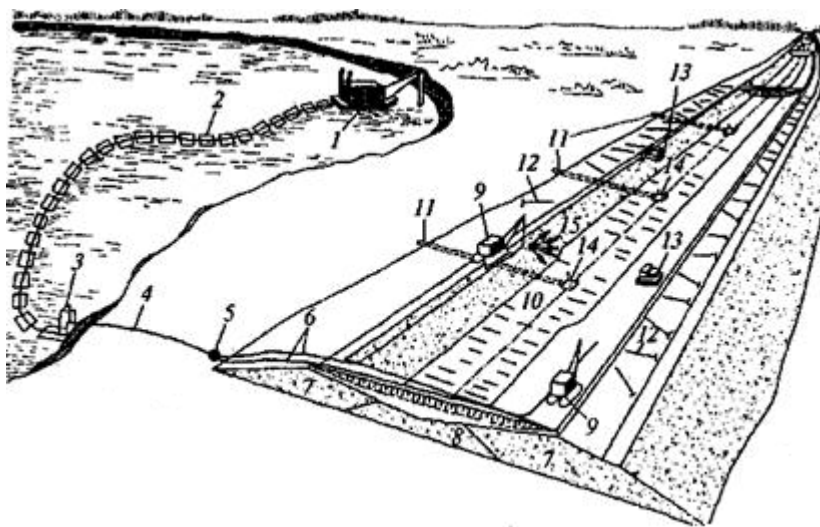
Схема организации работ при двустороннем безэстакадном намыве насыпи: 1 — земснаряд; 2 — плавучий пульпопровод; 3 — устройство для подключения плавучего пульпопровода к магистральному; 4 — магистральный пульпопровод; 5 — пульпопереключатель; 6 — разводящие пульпопроводы; 7 — боковые призмы; 8 — ядро; 9 — кран; 10 — прудок-отстойник; 11 — водосборные трубы; 12 — трубы для наращивания пульпопроводов; 13 — бульдозер; 14 — водосборные колодцы; 15 — направление потока пульпы.
